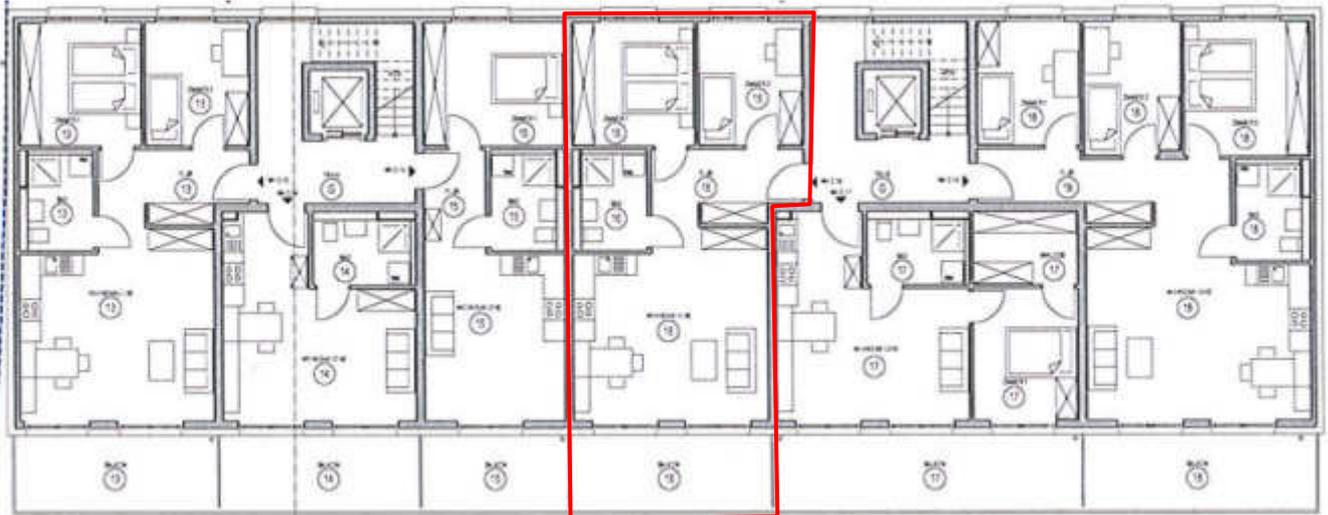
Grundriss Haus A-B, 2. OG (Ausschnitt ohne Maßstab); Quelle: Anlage 1 zur Urkunde 303/2021/ Teilungserklärung vom 10.02.2021, Roteintragung - Lage Wohnung Nr. 16 - durch den SV
